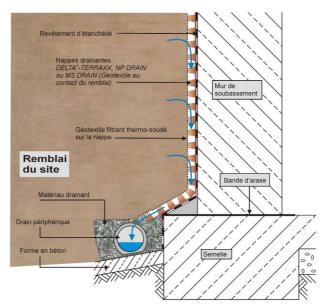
NEPE drainante – pied de construction sur étanchéité
